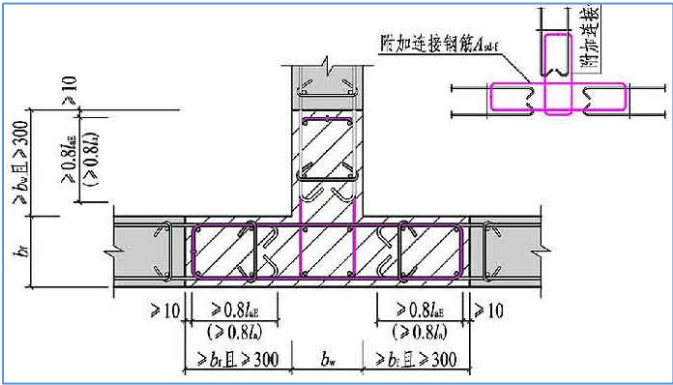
附加连接钢筋采用闭口箍筋形式
